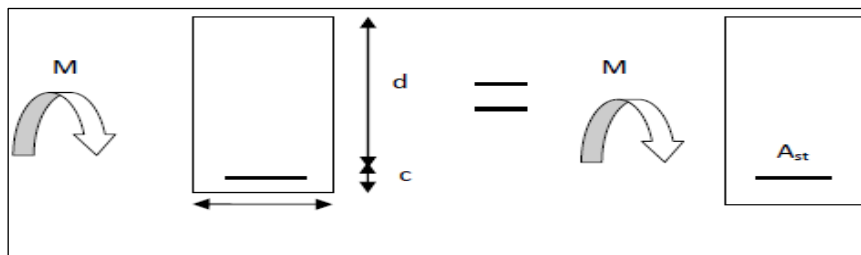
Schéma de Ferrailage des poutres simplement armée
